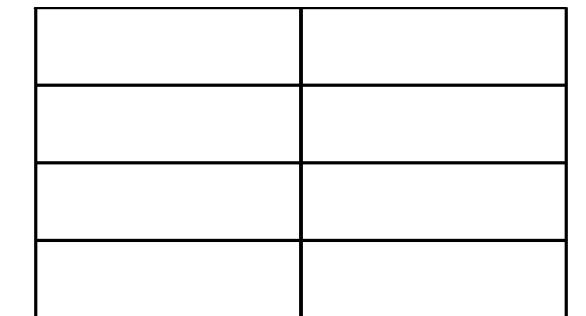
Pórtico de edificación con vigas unidas a cada pilar en cada planta
